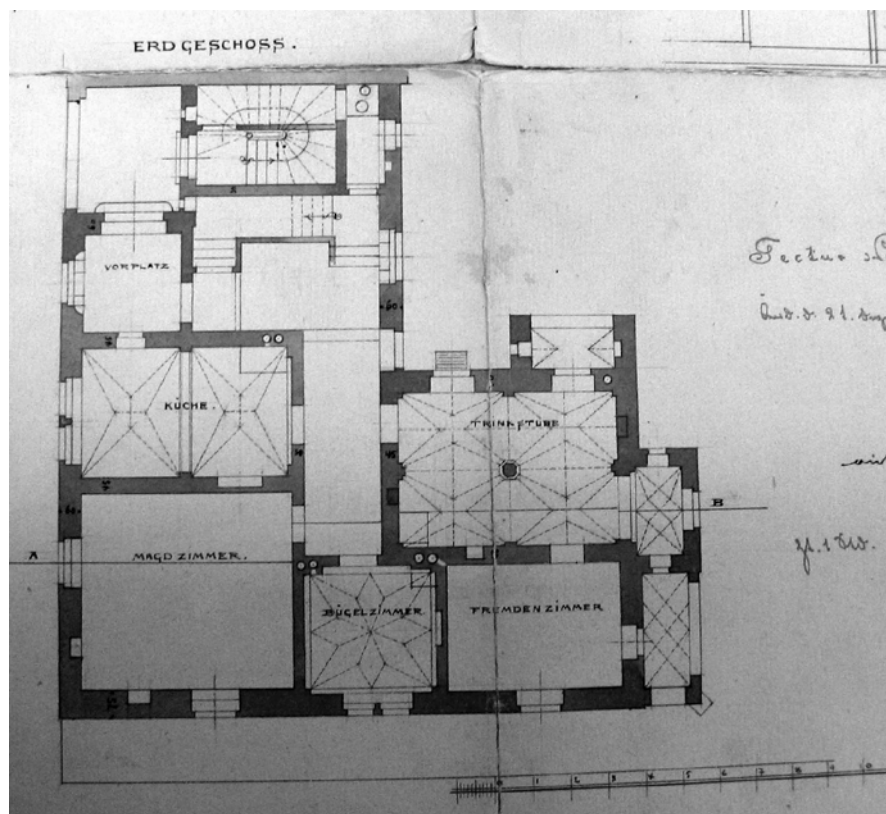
Grütznert-Haus, Grundriß Erdgeschoß, Leonhard Romeis, 1882, Plan nach Osten ausgerichtet.
